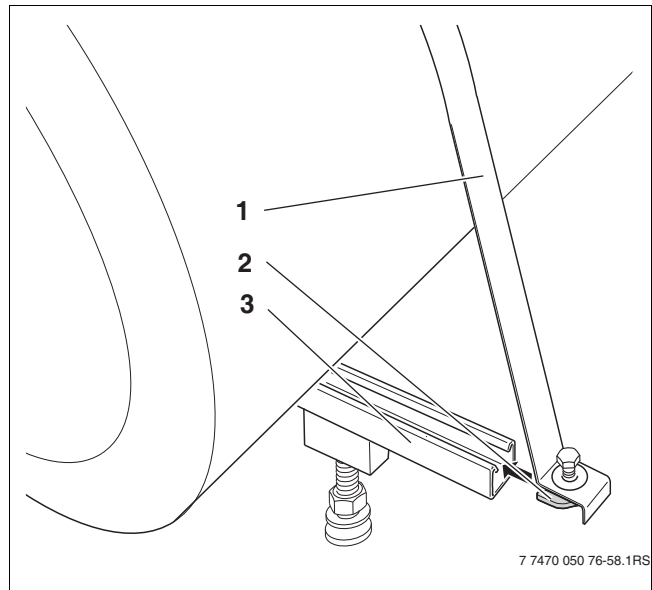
Vista montaje en tejado inclinado (sistema de 300 l)
